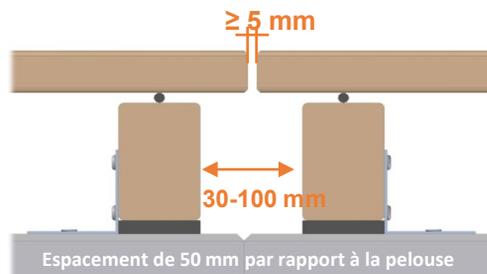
Planche de terrasse, scellée avec la cire d'étanchéité Kebony et installée avec la bande d'écartement Kebony, jointe sur deux poutres. Cette méthode garantit une longue durée de vie et simplifie le nettoyage.
